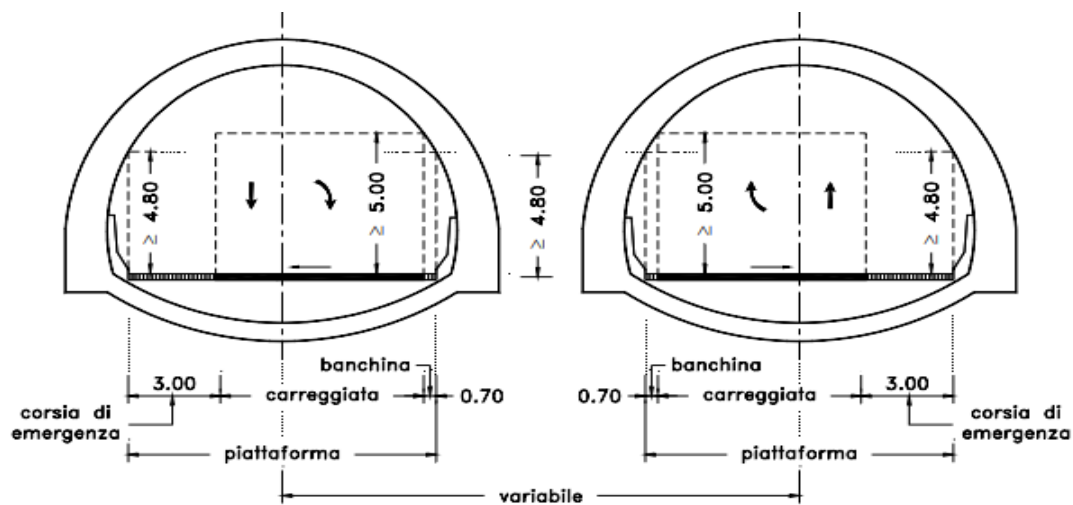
Sezione stradale per le gallerie ricadenti in strade di Tipo A (D.M. 5.11.2001)
